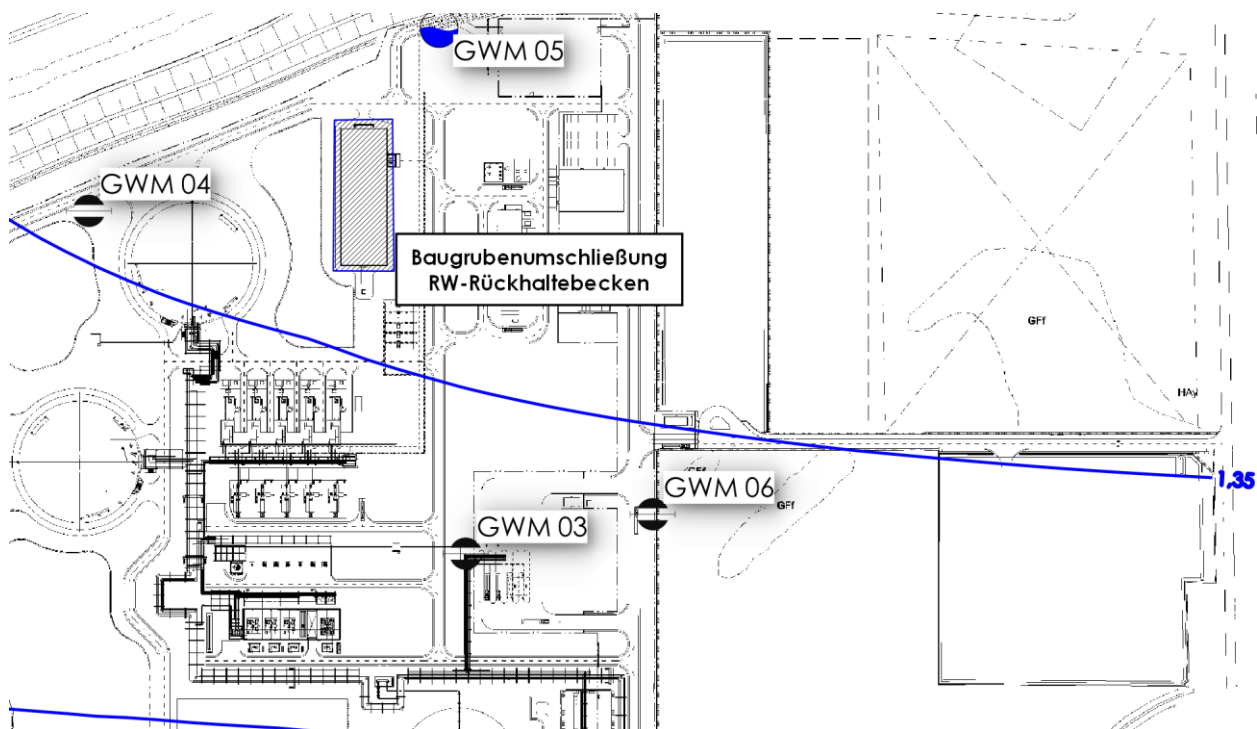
Lage des RW-Rückhaltebeckens und der umliegenden Grundwassermessstellen und berechnete Grundwassergleichen 1,35 mNHN (oben) und 1,30 mNHN
